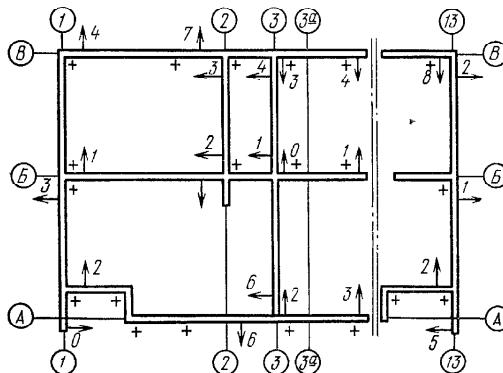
Исполнительная схема блоков ленточного фундамента (стрелками показано направление отклонений блоков от осей, крестиками — места нивелирных точек; условно смешены)
